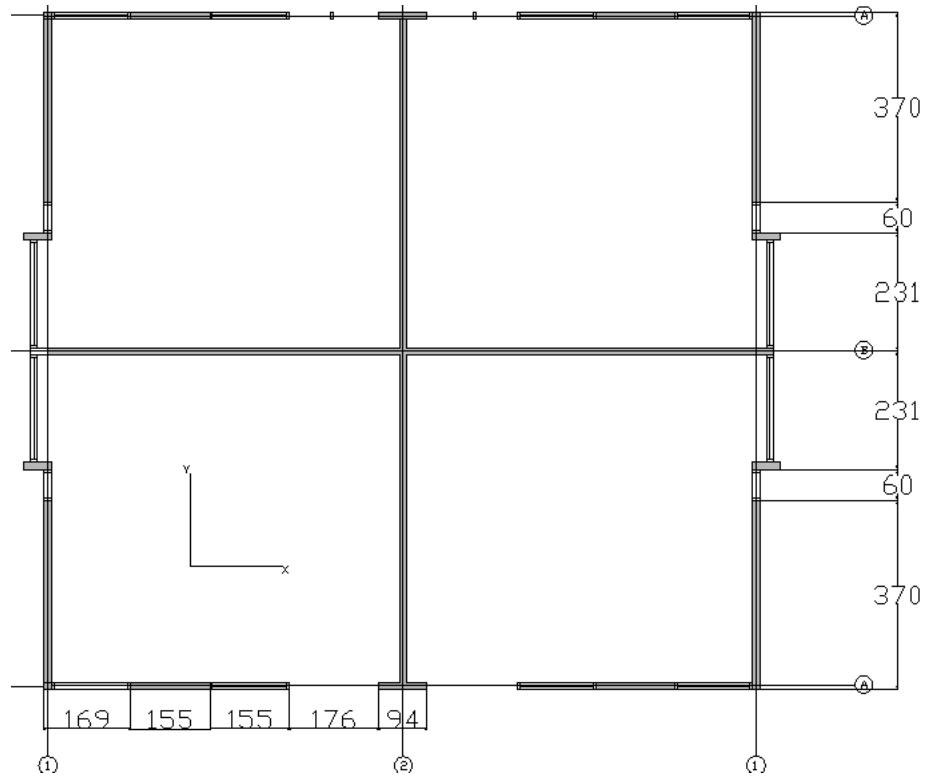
12. Planta tipo edificio 4 Pisos Tipo A
